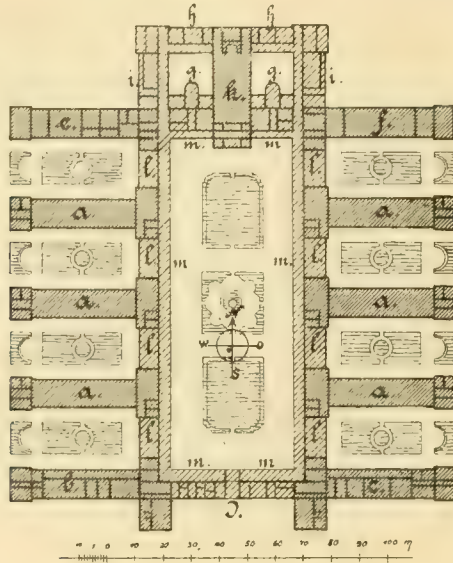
Nottingham-Epidemie-Hospital. Lageplan.
